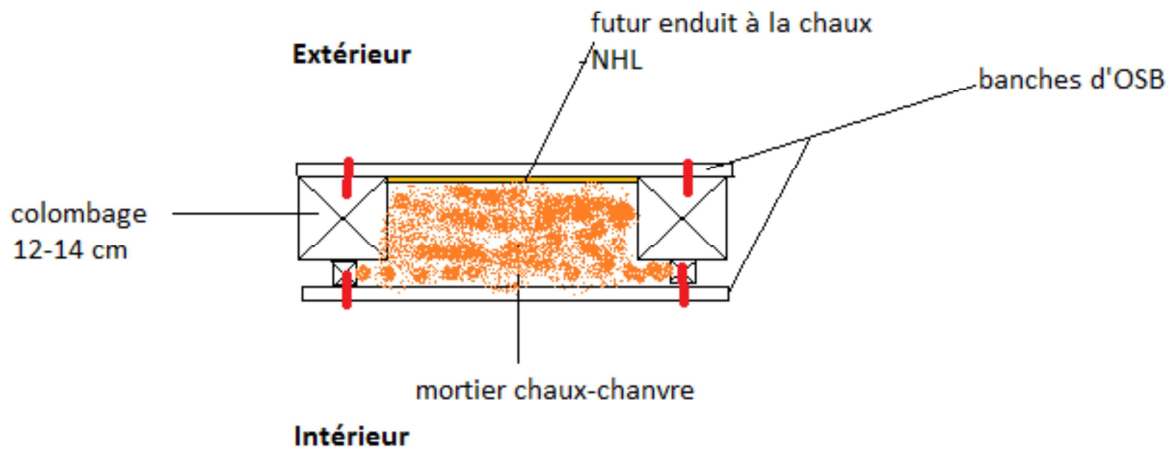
Coupe horizontale de l'enduit banché de la partie en pans de bois
